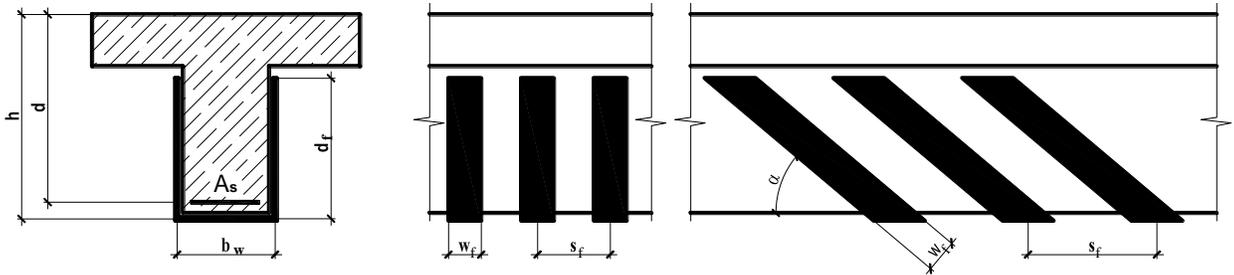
Размещение СВА хомутов для усиления наклонных сечений
